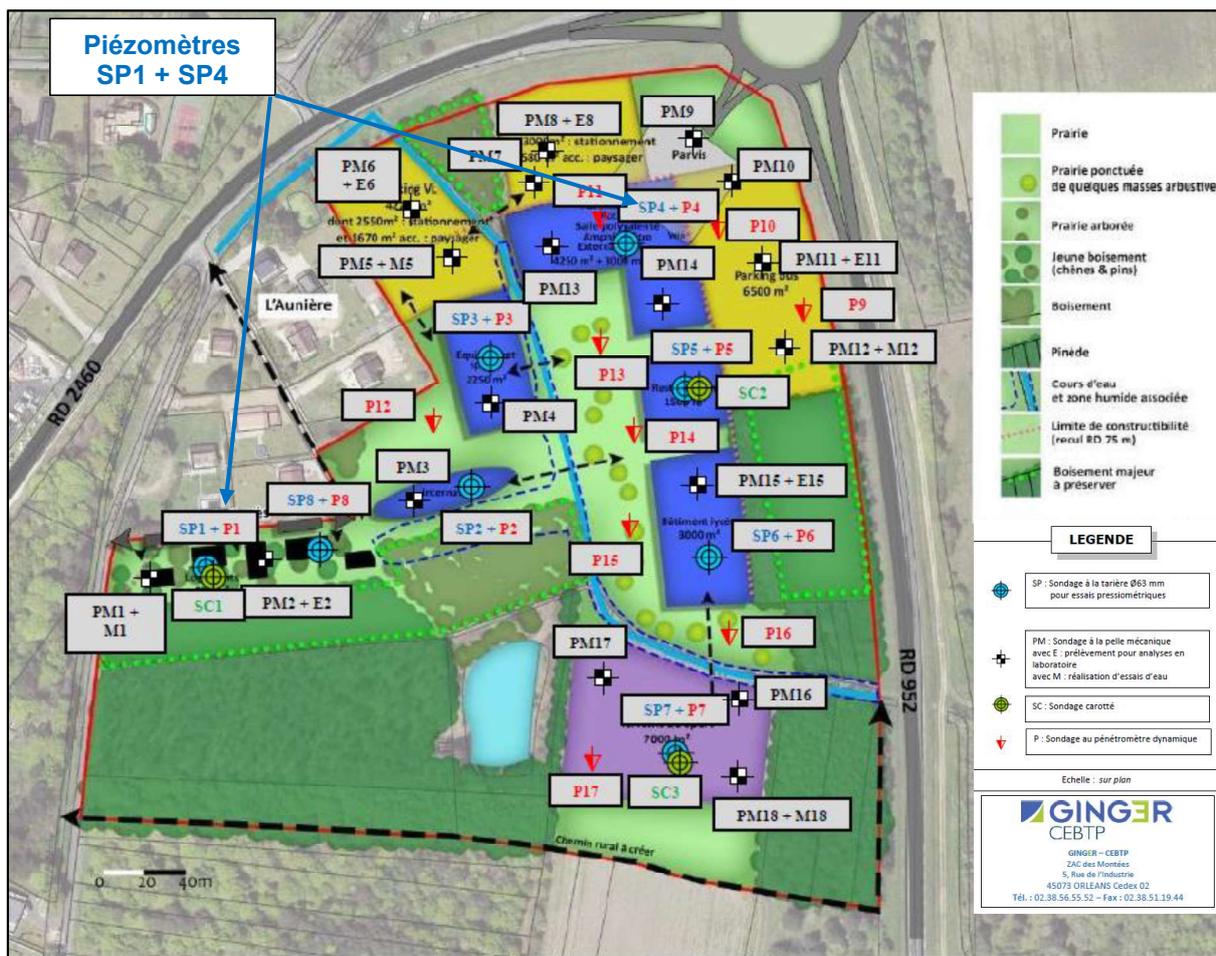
Plan d'implantation des sondages (Extrait du rapport géotechnique de GINGER CEBTP- Février 2020)
